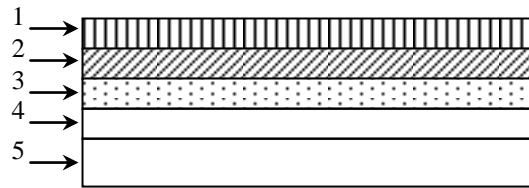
Coupe verticale d'un plancher étage courant - corps creux
